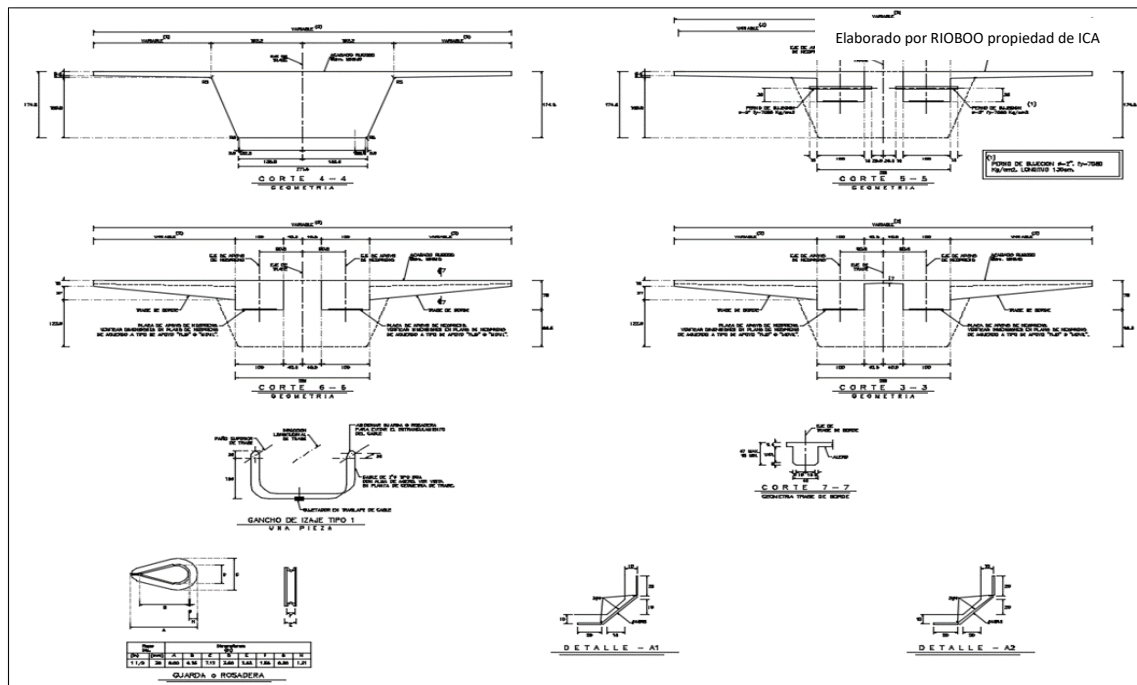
Plano estructural trabe tipo tramo Insurgentes
